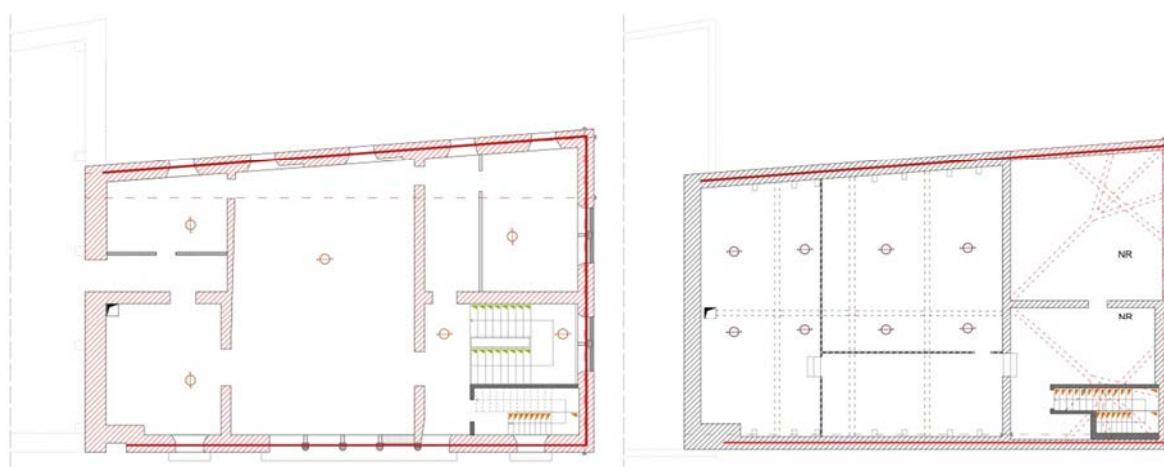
Caratterizzazione materica, piano secondo e copertura.
